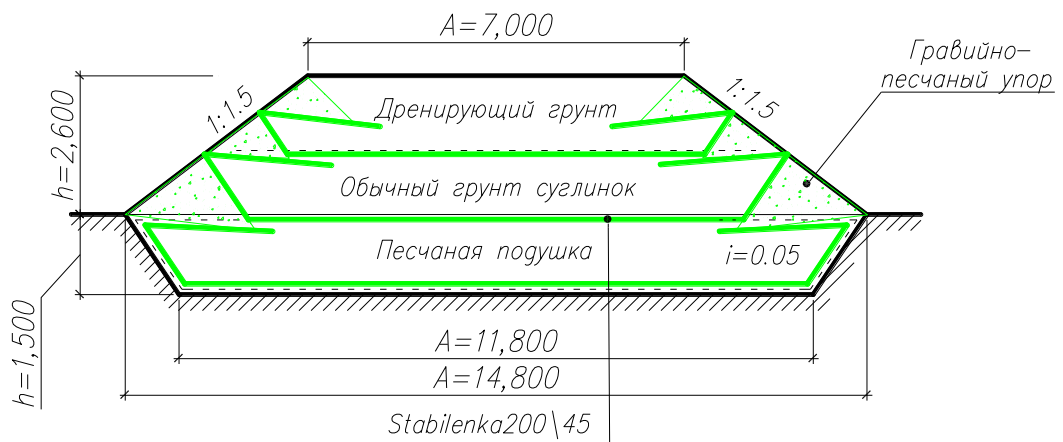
Конструкции армированной геотекстилем насыпи земляного полотна тремя геотекстильными укрепляющими прокладками и гравийно-песчаным упором;
